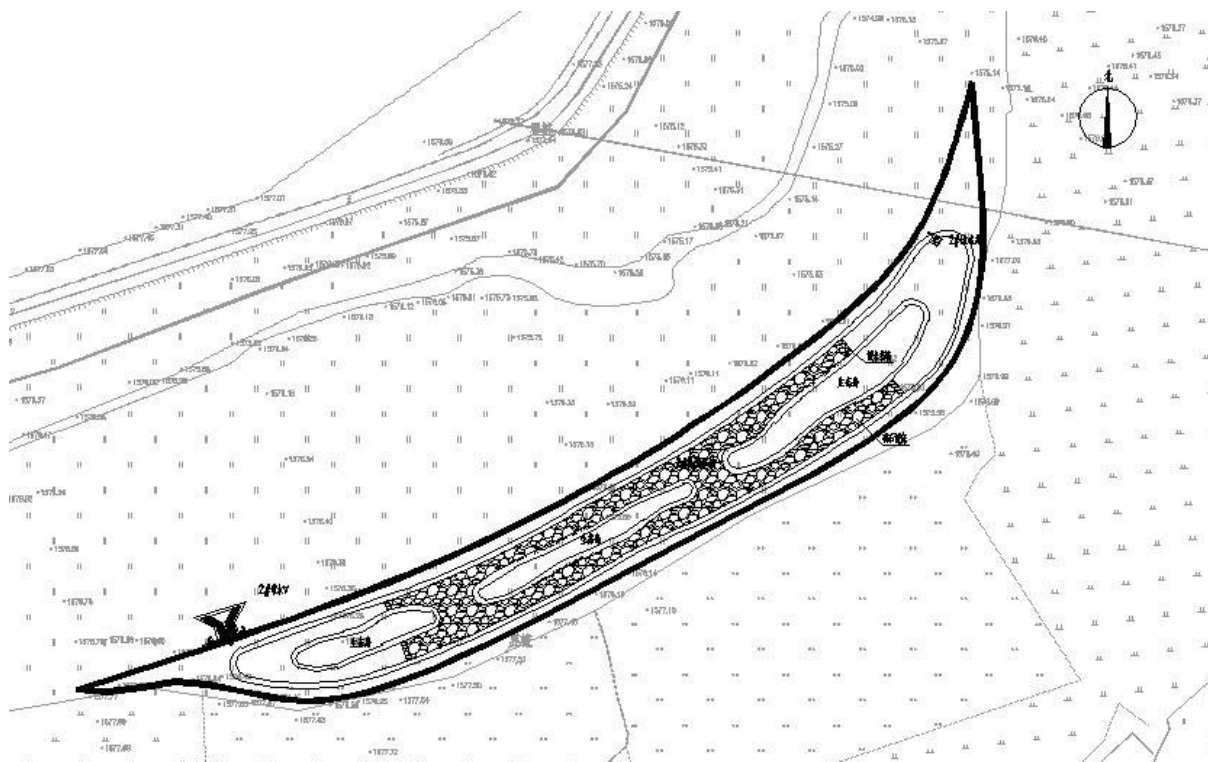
冬至水库北侧水生态修复区一总平面布置图
